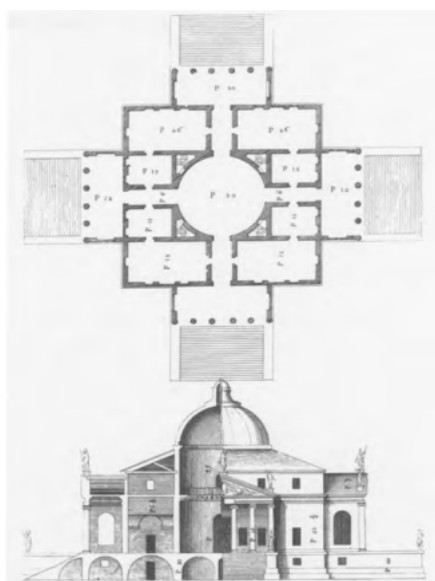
Le plan de Palladio de la Villa Rotonda (Palladio, 2002).
